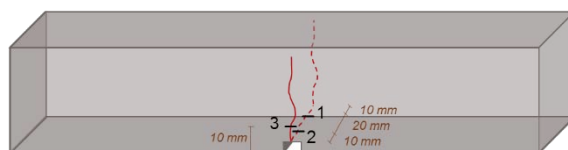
Puntos de medida del cierre de fisuras en las probetas de mortero
